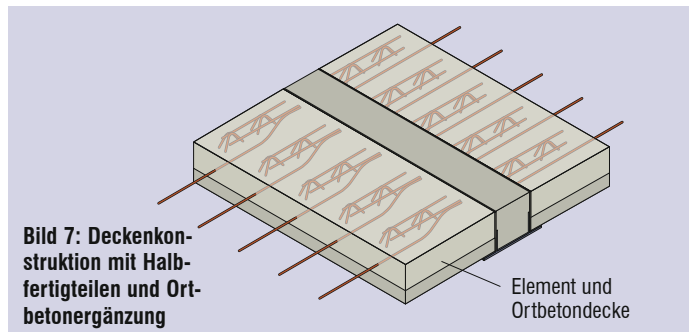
Deckenkonstruktion mit Halbfertigteilen und Ortbetonerfüllung
